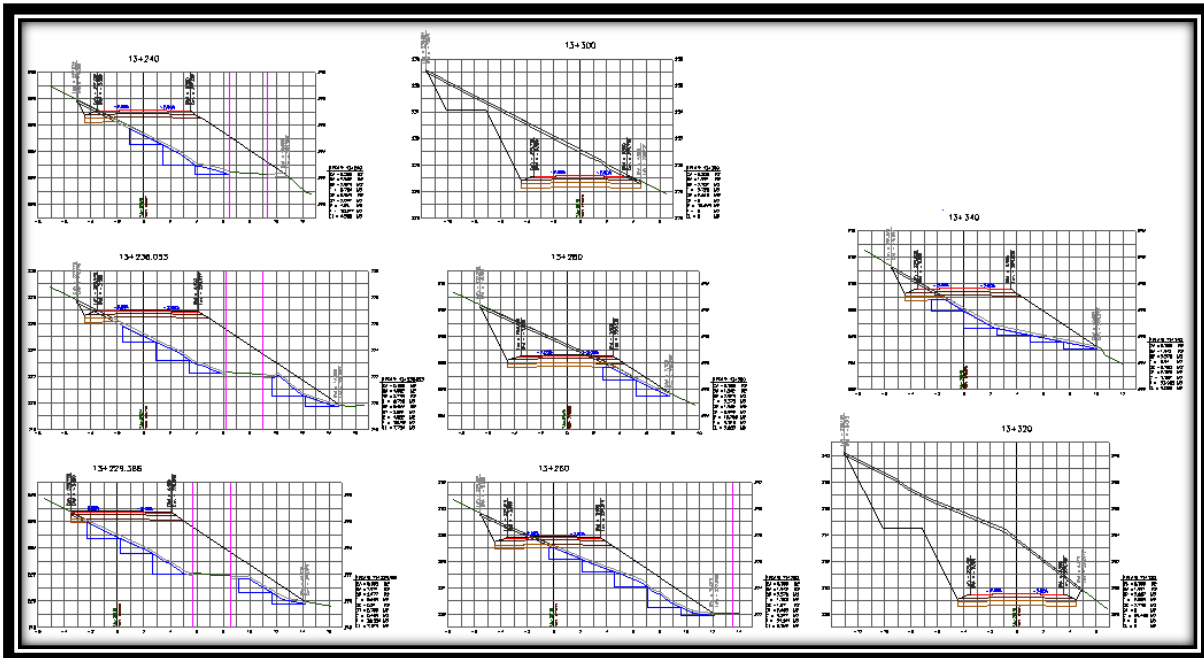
Secciones de construcción del km 13+229.386 al km 13+340.000.
